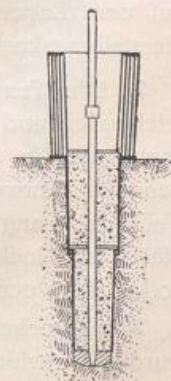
Herstellung eines Beton-Stampfpfahls in weichem Boden.
